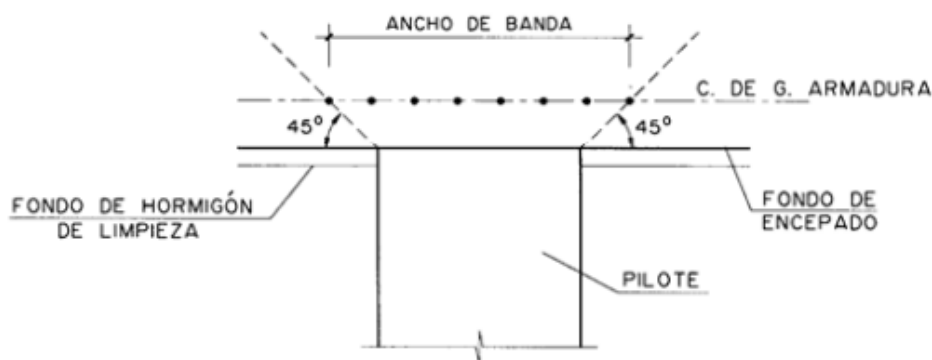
Definición del ancho de banda de las armaduras principales. (Fuente: EHE-08)
